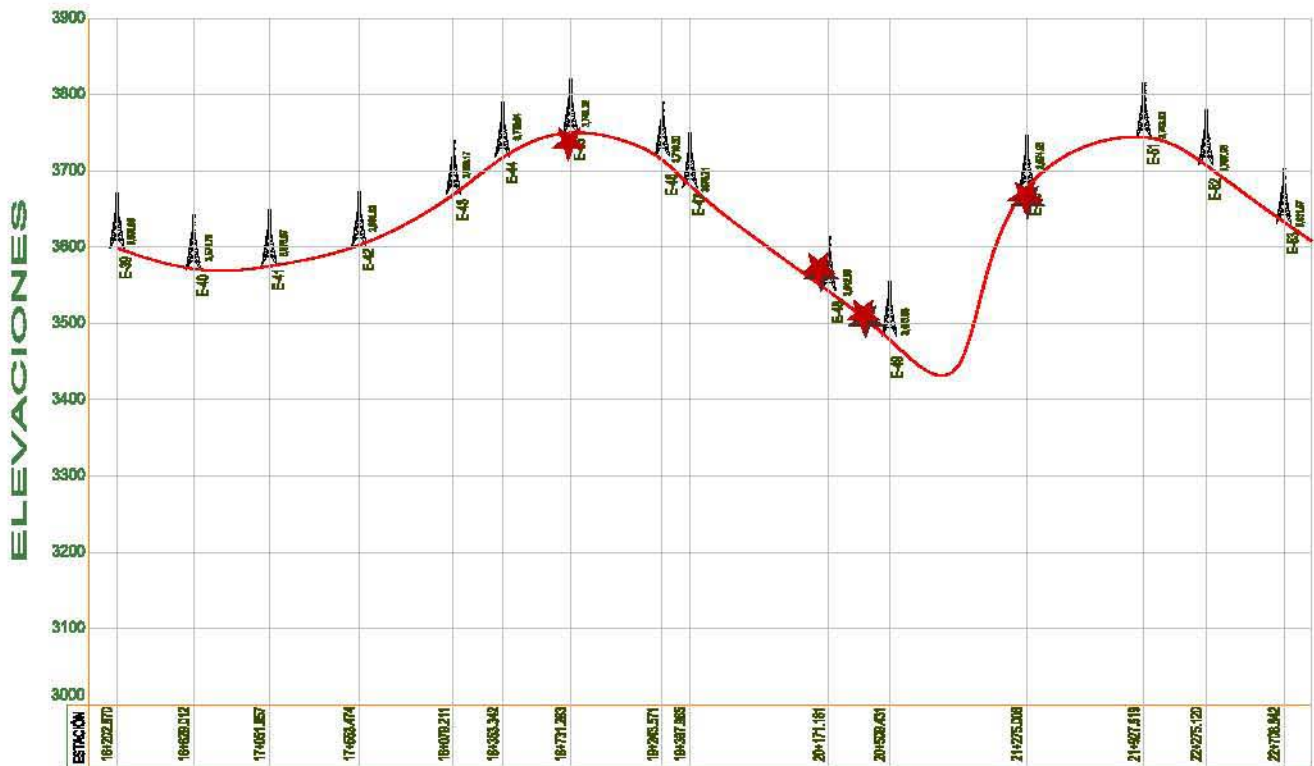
Perfil de las LT's TOP-A3510/A3520-BRN, en la zona de la falla.
